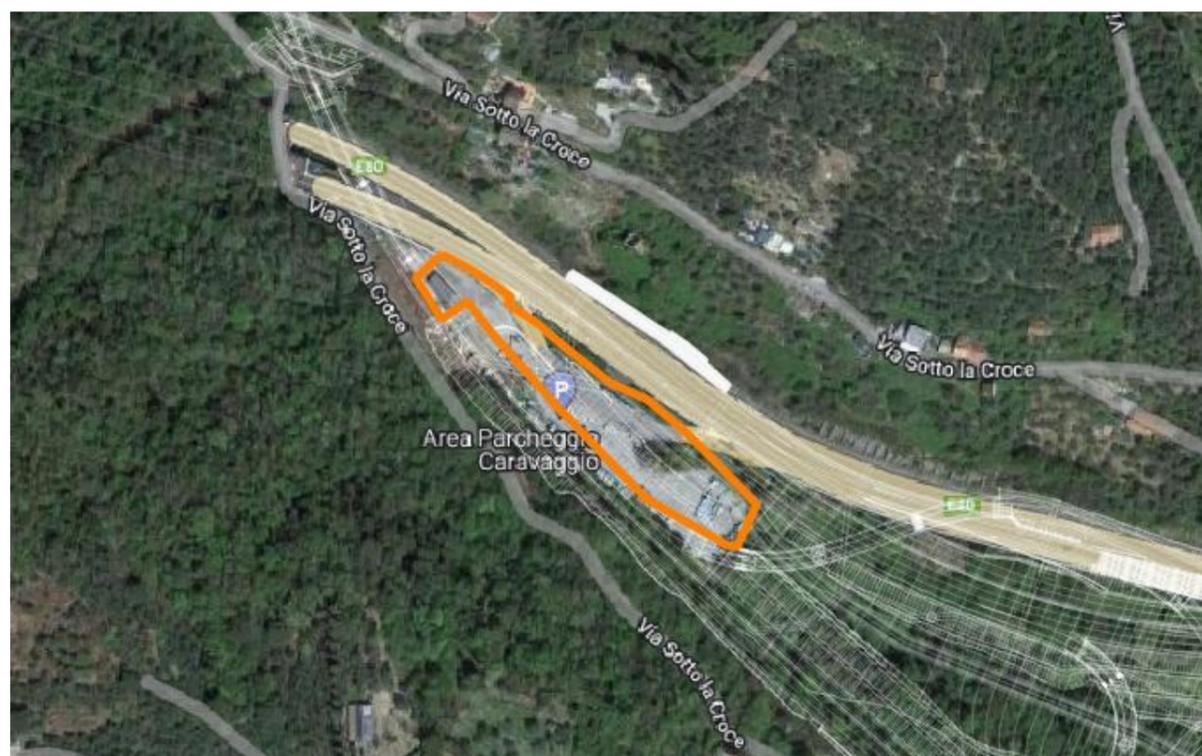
Localizzazione Cantiere di imbocco Lato Rapallo
